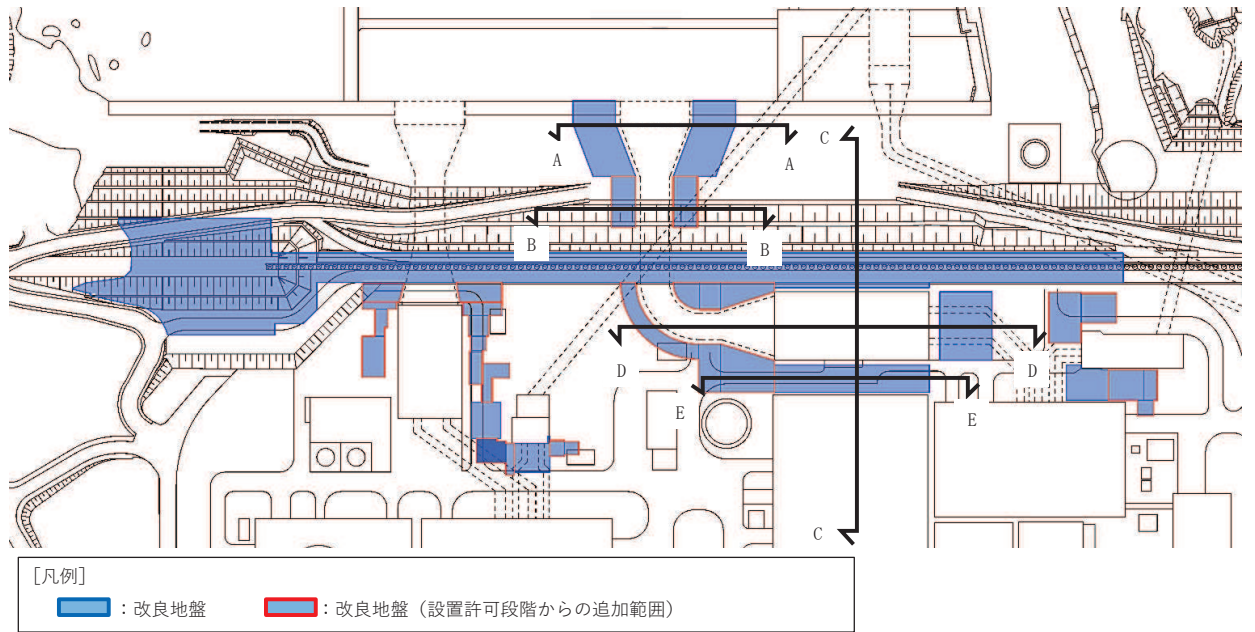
地盤改良体の配置図 (取水口, 取水路, 海水ポンプ室, 原子炉機器冷却海水配管ダクト)
